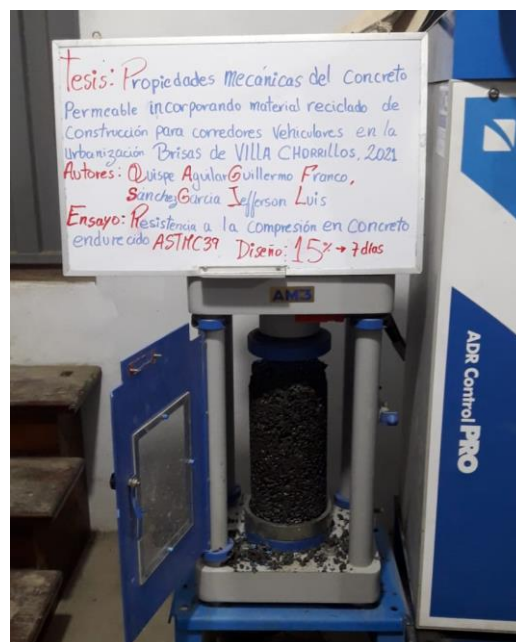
Rotura de Concreto Patrón + 15% de agregado reciclado
